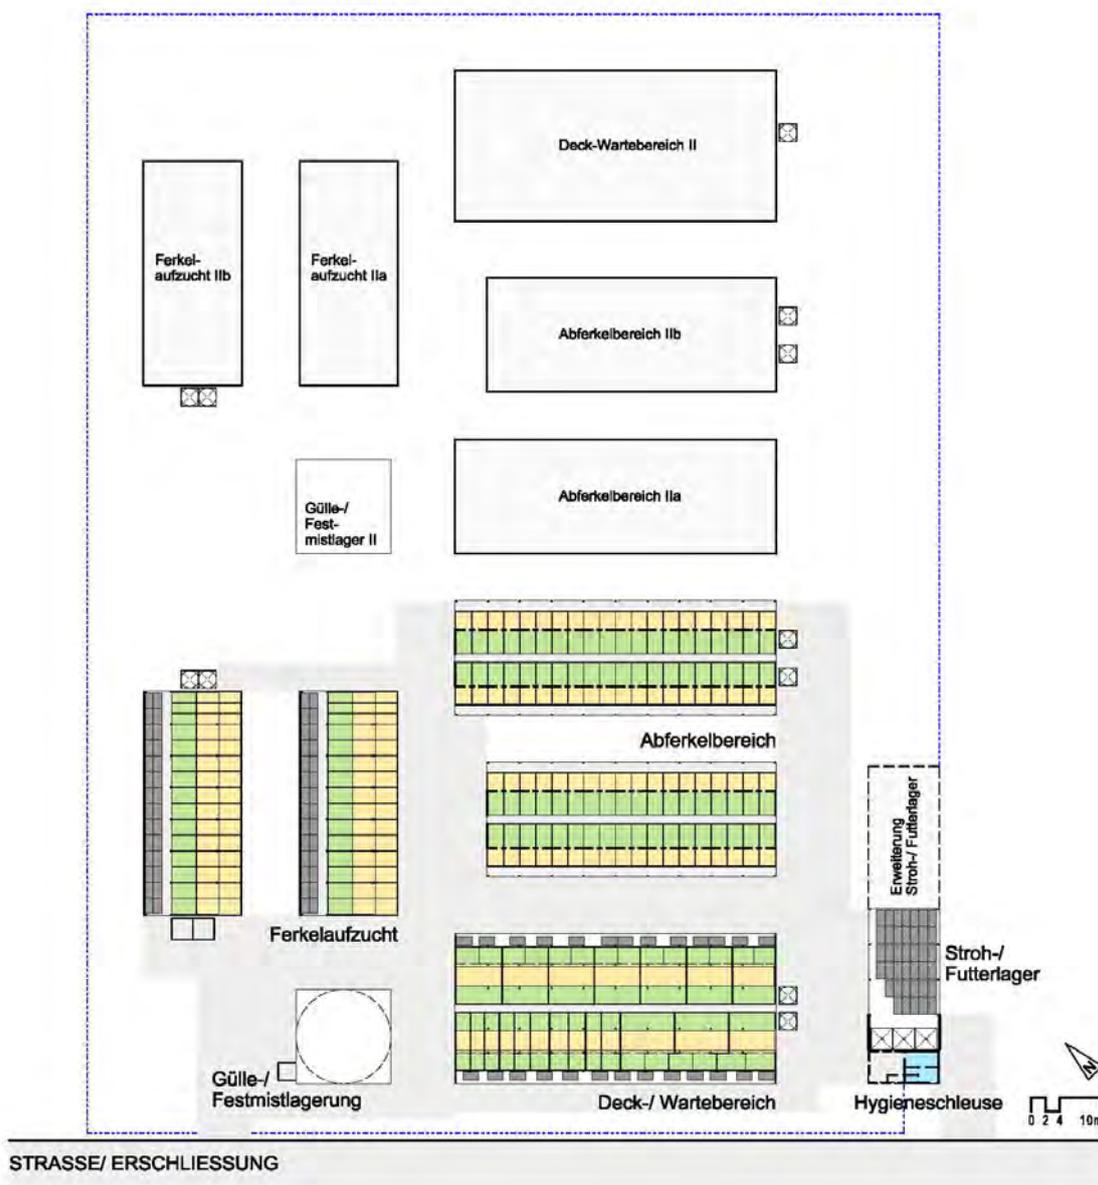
Lageplan Modell I; Wachstumsschritt des Bestandes von 168 auf 336 Sauen
